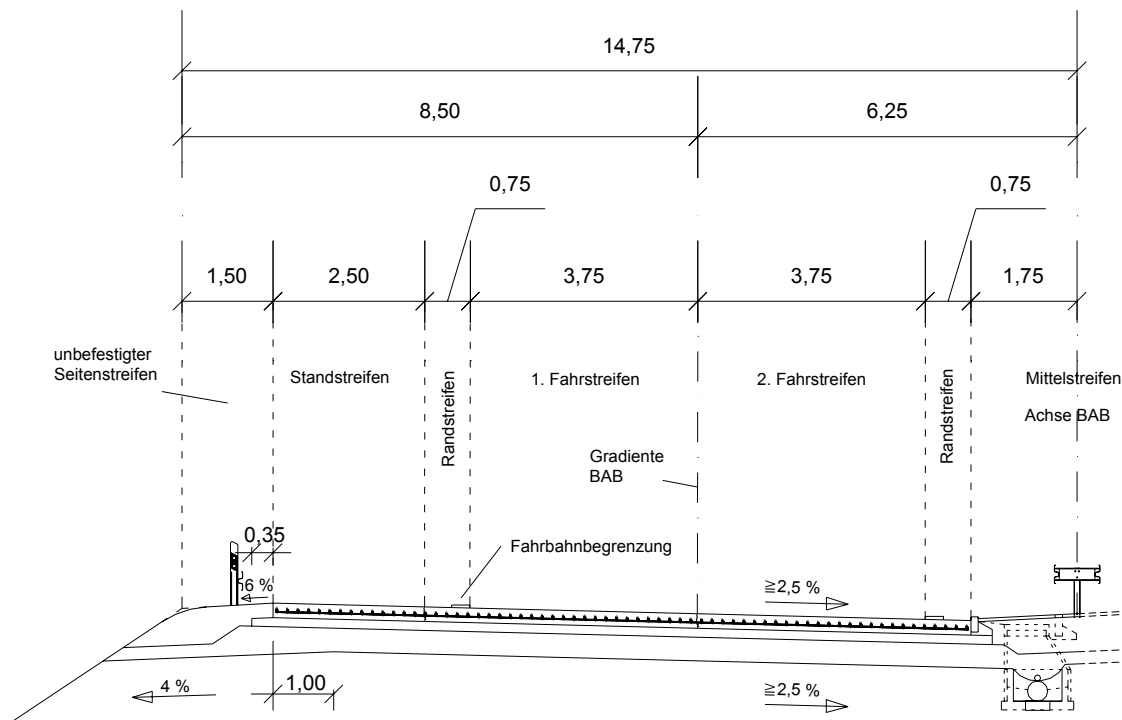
Detail Querschnitt Deckenaufbau einer durchgehend bewehrten Betondecke für Bauklasse SV
